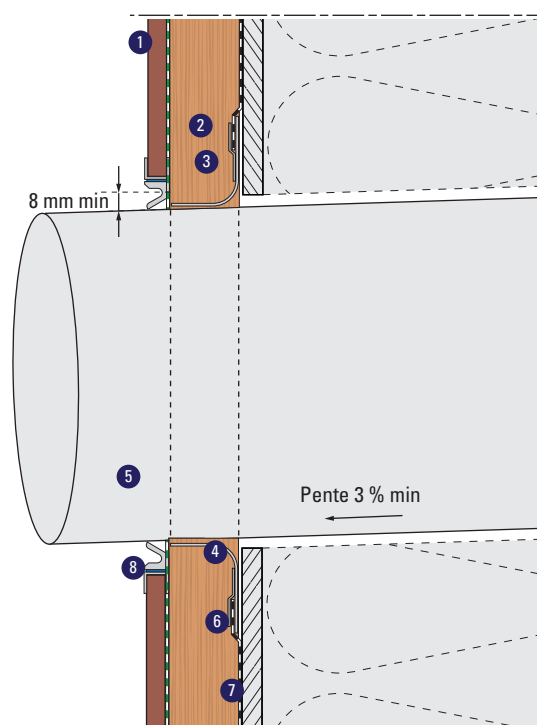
Exemple de traitement de la traversée d'une paroi - coupe verticale
